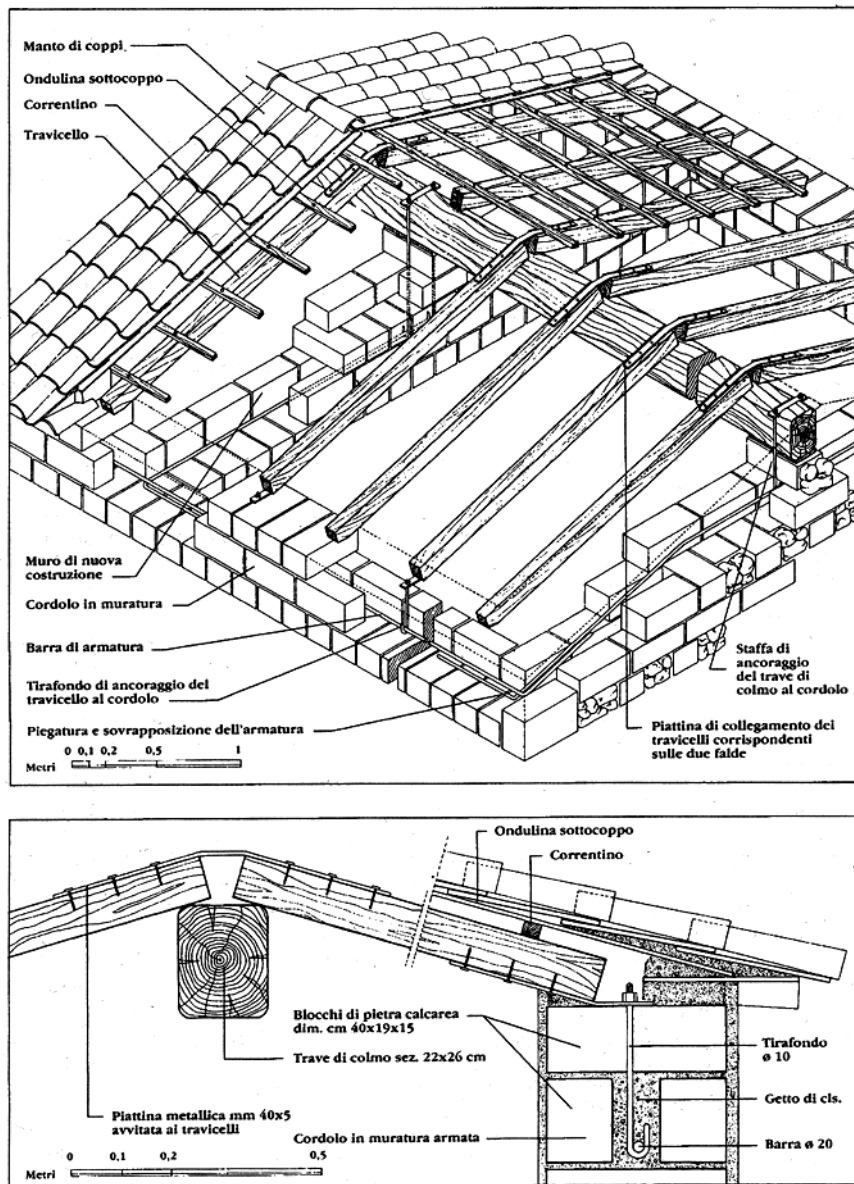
Dettagli costruttivi di intervento su un tetto in legno (7).
